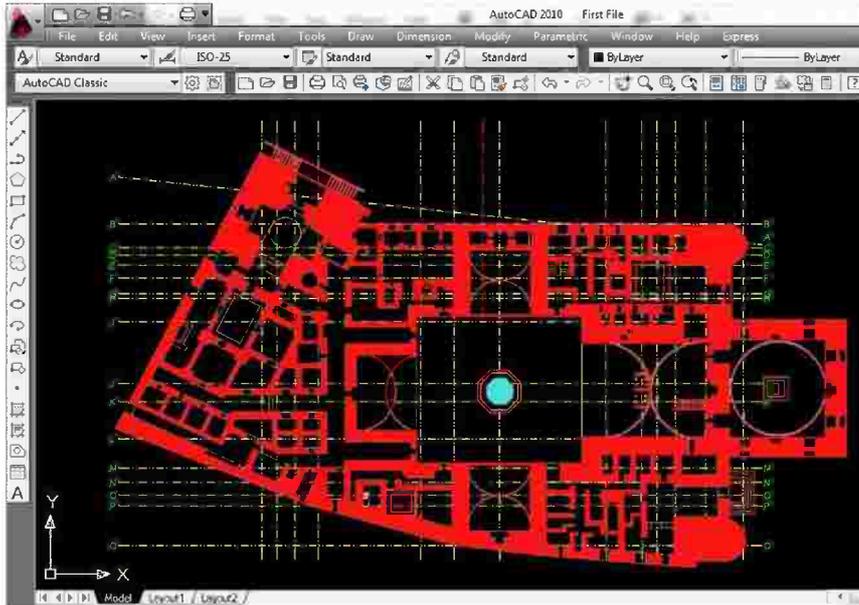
/١/٢) : مسجد الناصر محمد – مسقط أفقي – القاهرة .
